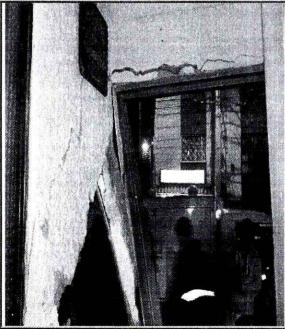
Vista del fisuramiento en los dinteles del muro de fachada a causa del impacto del vehículo.
